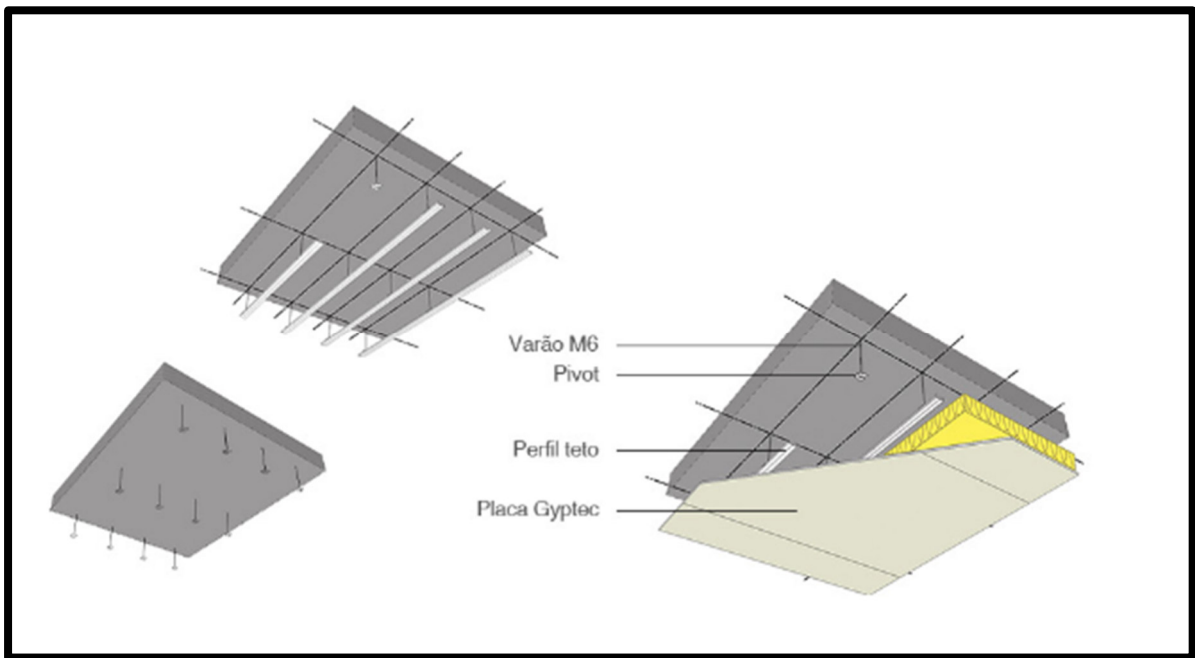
Detalhe colocação teto falso - exemplo Gyptec
